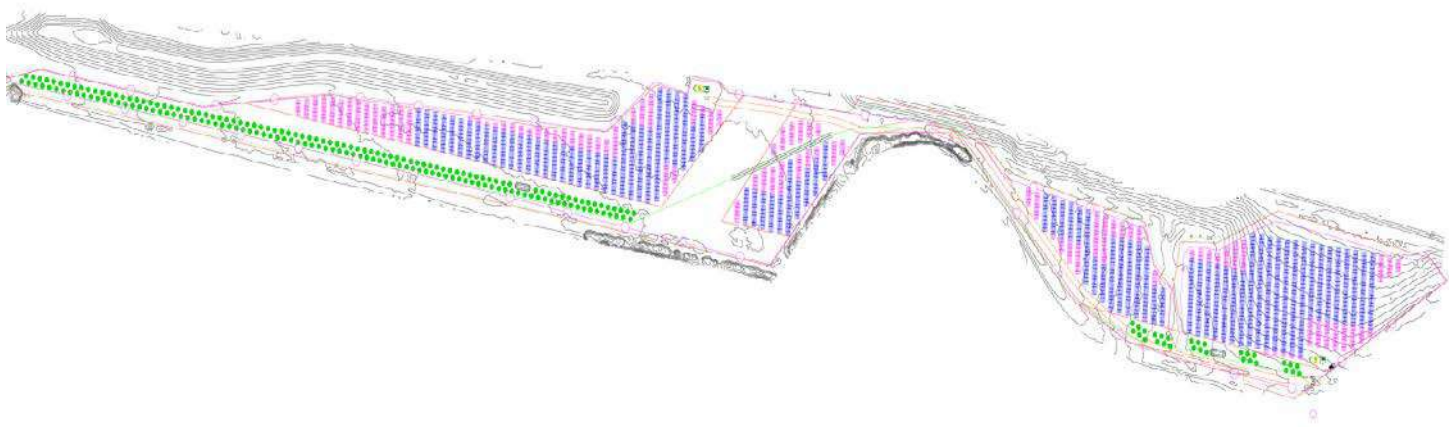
Plan de Masse - Centrale Solaire RpGlobal Chasseneuil/Jaunay
